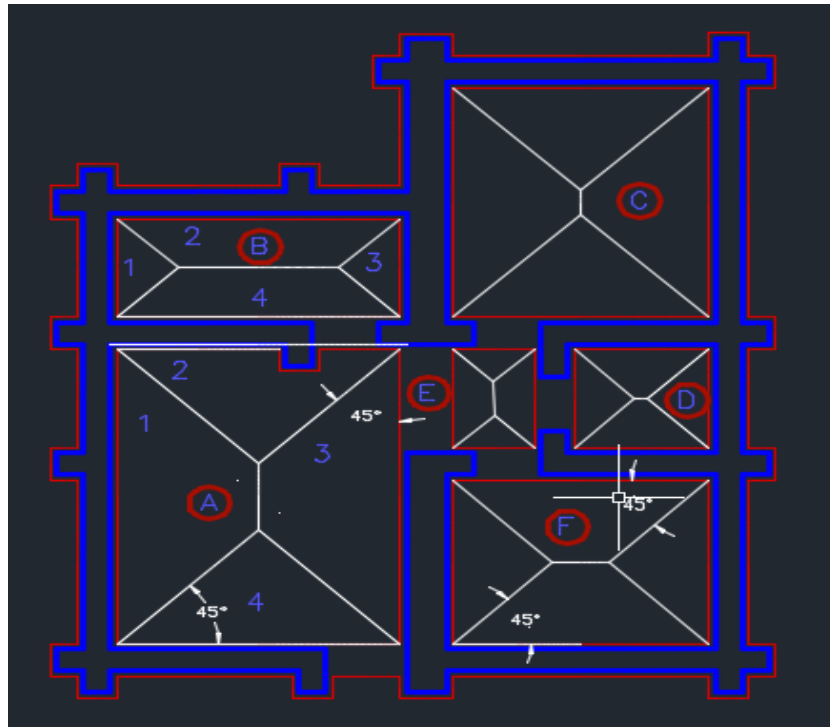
Modelado de la estructura – vista en planta, áreas tributarias. Fuente: Elaboración propia.
